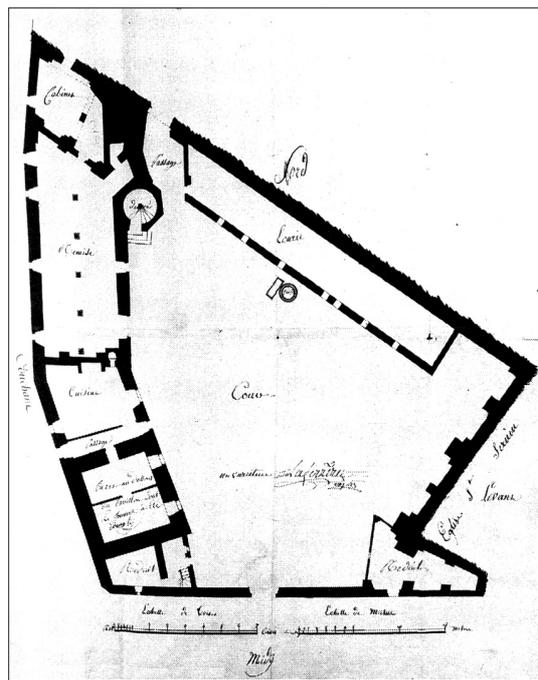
LAFERRERIE : PLAN DU LOGIS
